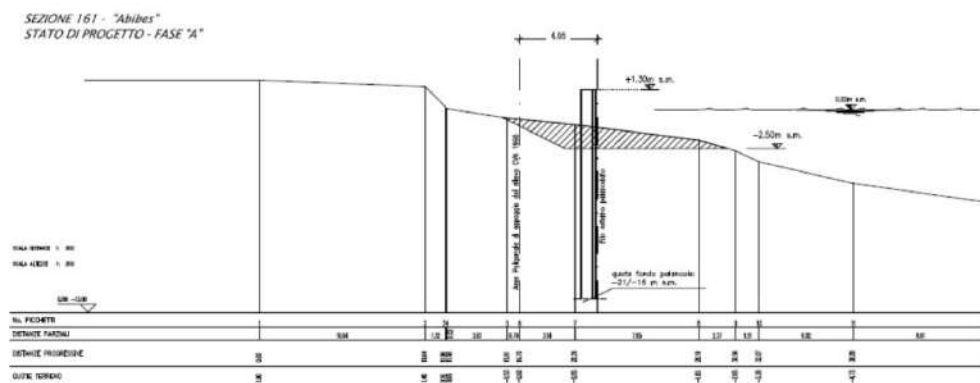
Sezione con indicazione della quota del fondale attuale e del posizionamento delle palancole
